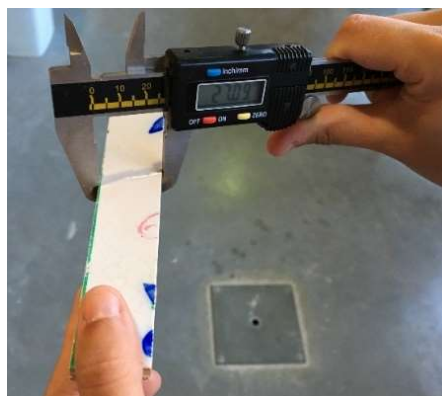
Medição da fissura da amostra com a craveira.
